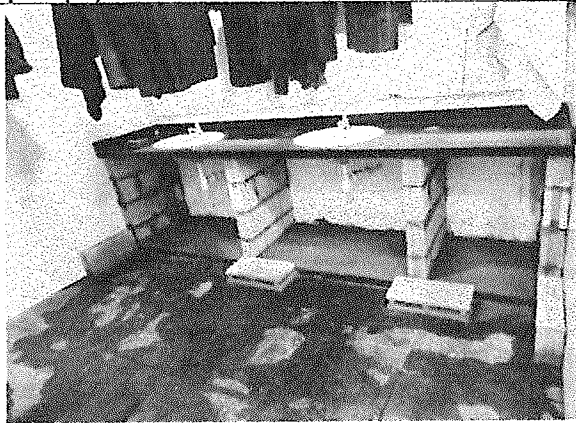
ESTACION SUR (filtraciones fachadas y cubiertas)
